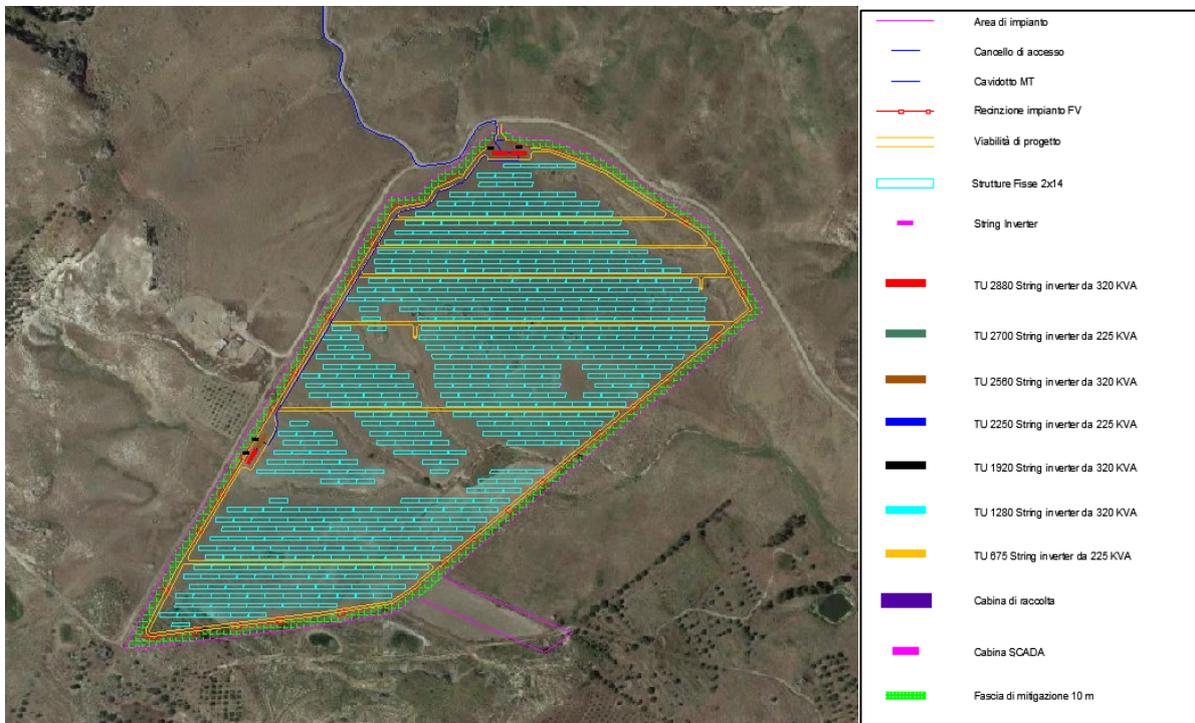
Sovrapposizione su ortofoto del layout di impianto – Lotto 4
